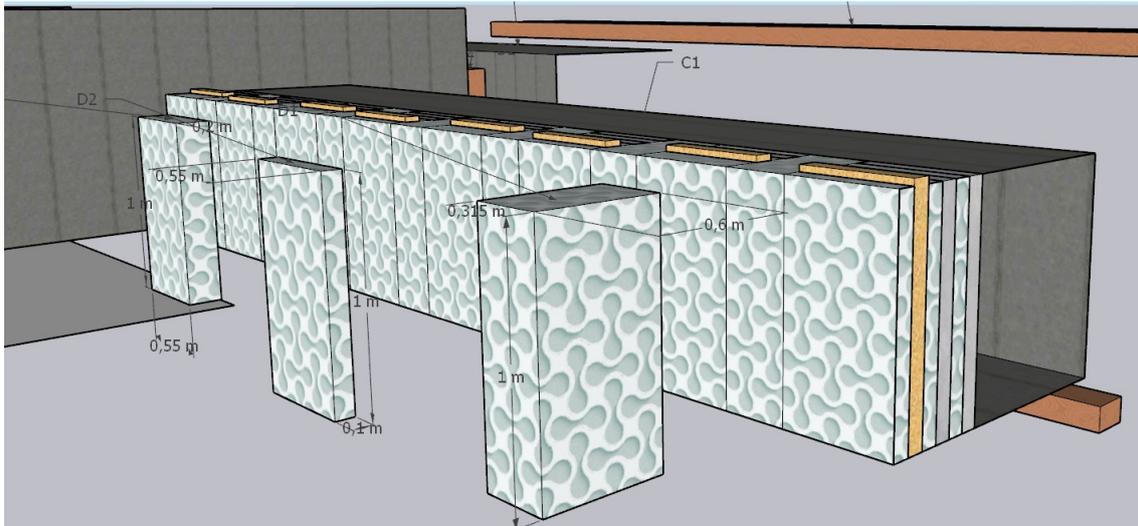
Detalle constructivo del encofrado con los paneles
